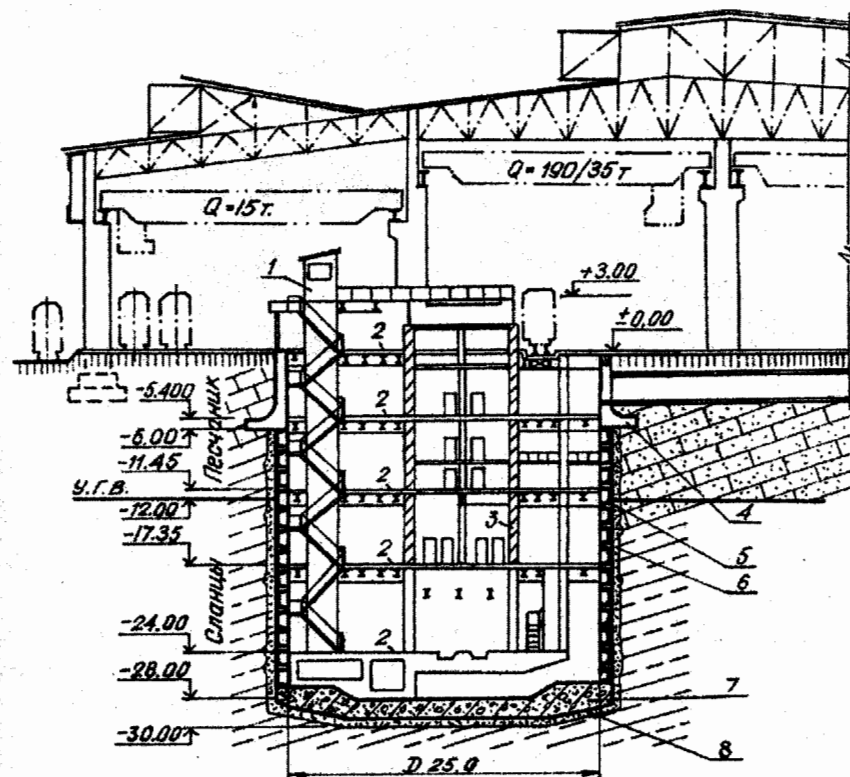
Схема установки непрерывной разливки стали в г. Донецке:
